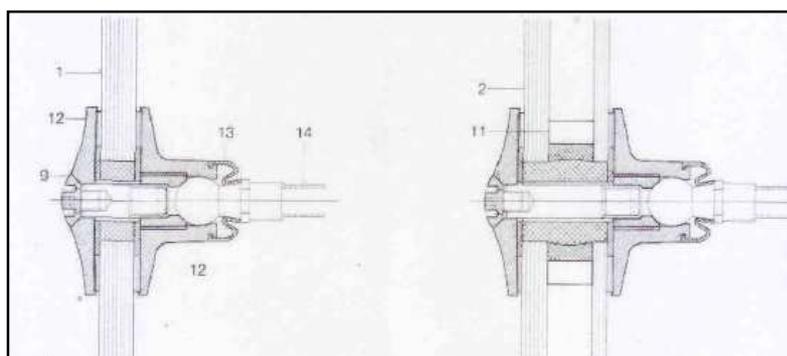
Esempio di fissaggio non sul piano di superficie, con articolazione esterna al piano di lastra
